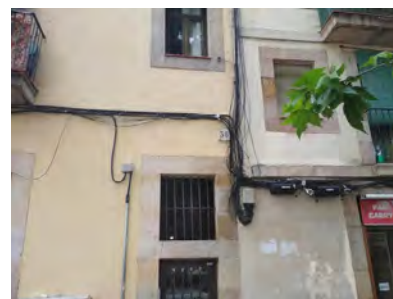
Cableado trepando por la fachada de los edificios.
